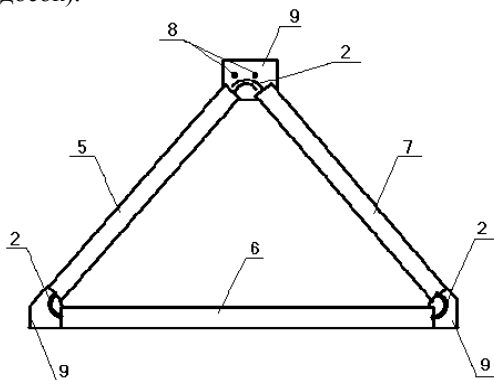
Сечение сборно-монолитной железобетонной балки полой треугольной формы
